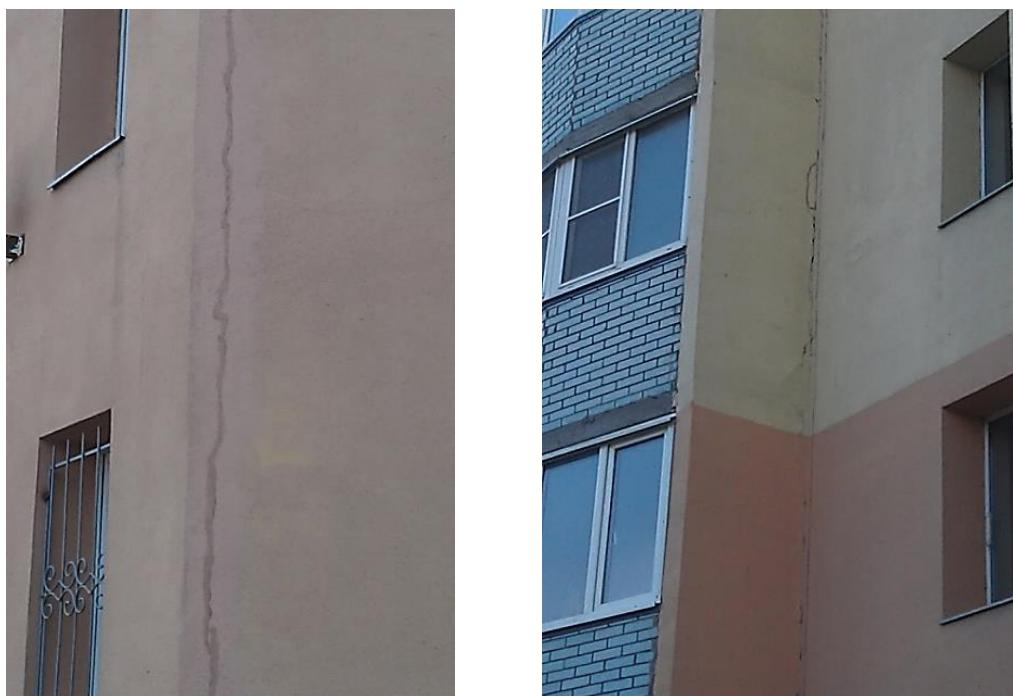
Дополнительное утепление фасада с оштукатуриванием тонким слоем без усиления армирования в угловых зонах здания
